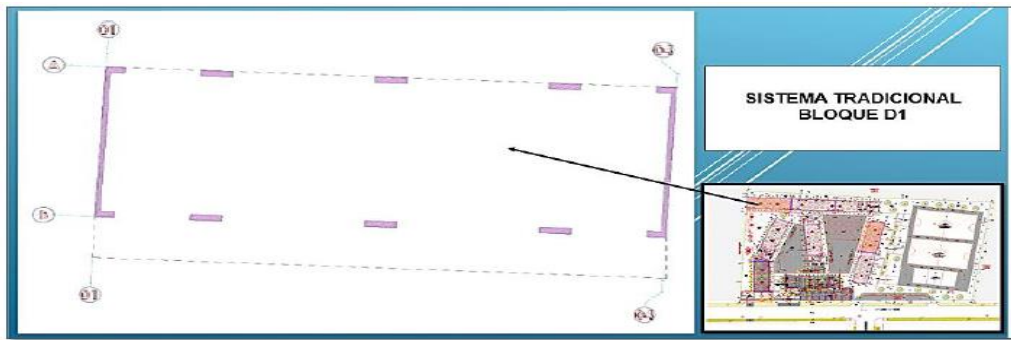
Sistema Tradicional – Bloque D1. (Fuente Propia).
